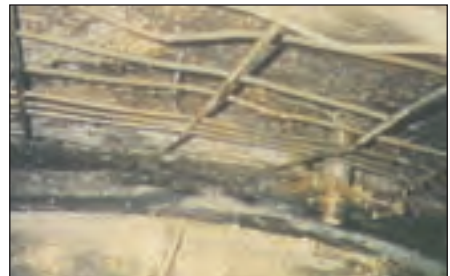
Detalles del incendio en el Túnel Canal de la Mancha
